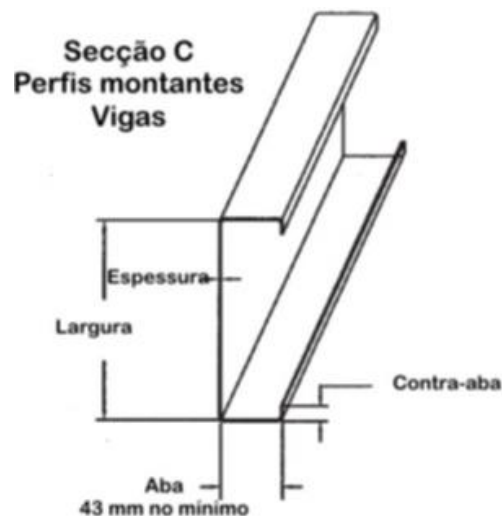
Exemplo de uma secção C de um perfil de construção de paredes LSF.
